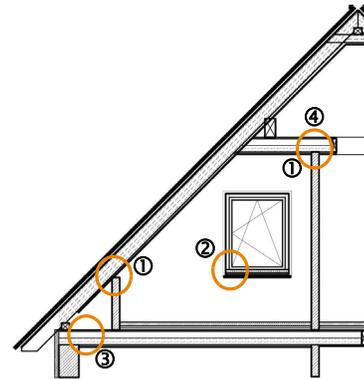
Bei einem nachträglichem Dachausbau kann der Handwerker lediglich einzelne Bauteile luftdicht herstellen (hier Dach- und Deckenflächen im Dachgeschoss). Durchstoßende Bauteile werden nicht bearbeitet und bilden potenziell Luftundichtigkeiten (Abb. C2.4).
